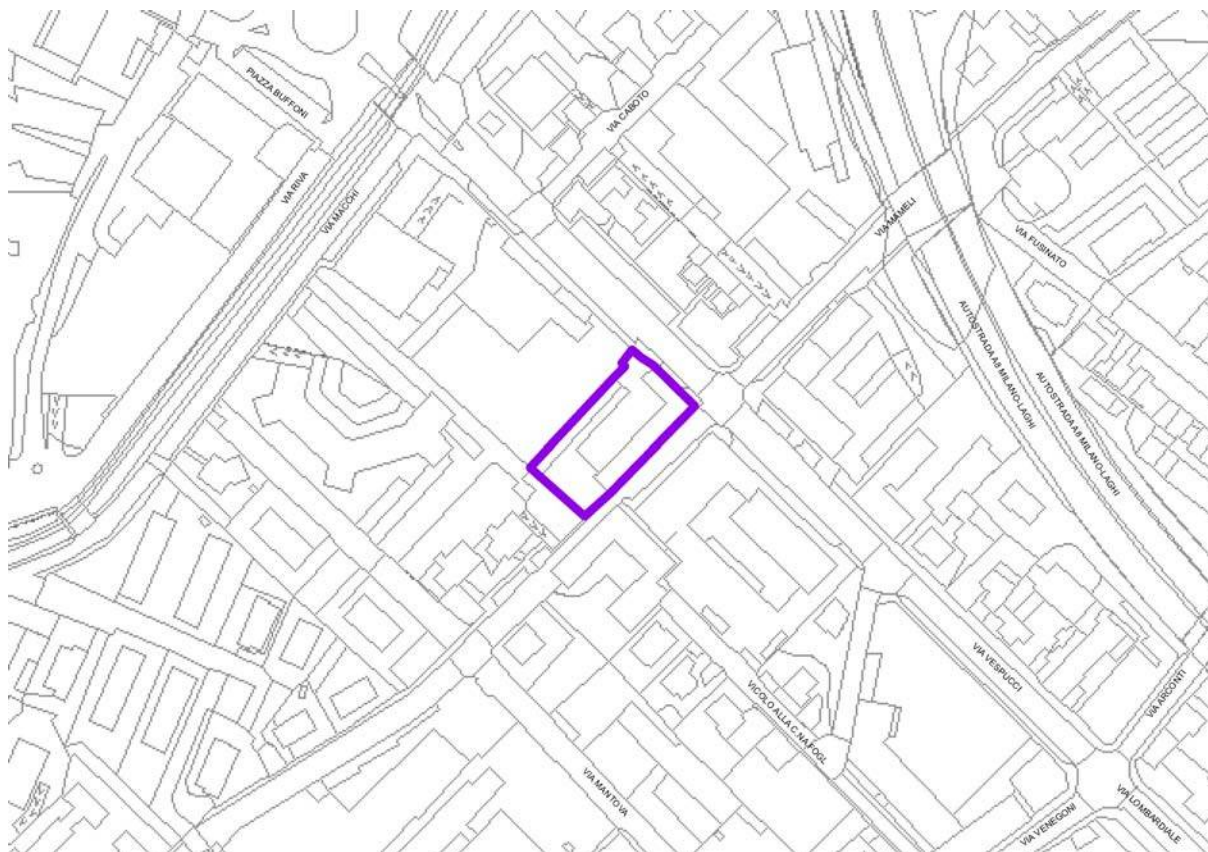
Planimetria dell'antica Tessitura Crosta PRS6
